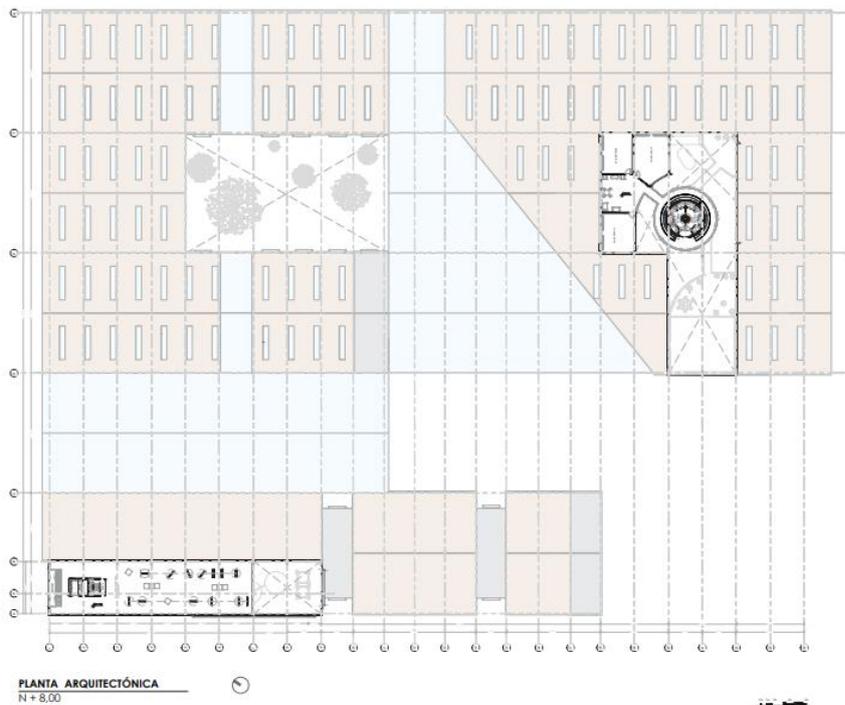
Planta arquitectónica N+8.00 Escuela de Artes - Museo
